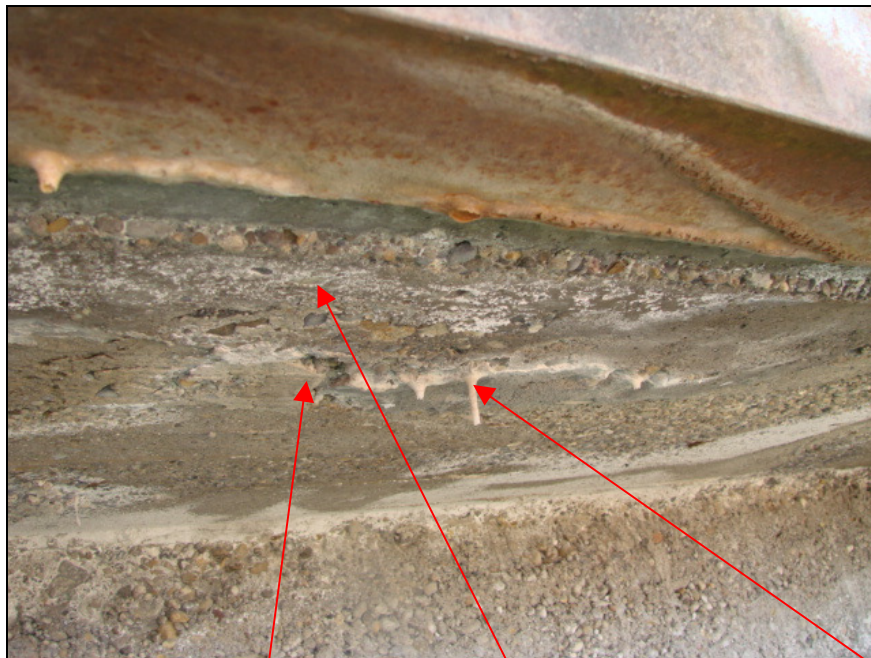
Untersicht der Kragplatte. Salzausblühungen und starke Kalkaussinterungen mit Stalaktitenbildung. Der Beton liegt hohl und löst sich ab.
